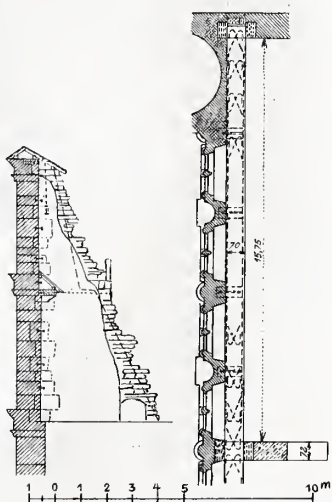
Grundriss und Schnitt. Masstab 1 : 300.
